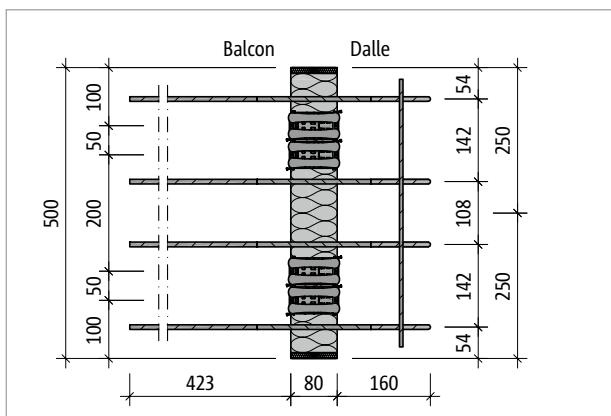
Schöck Isokorb® T type Q-E-W-V4-L500 : plan de base du produit
